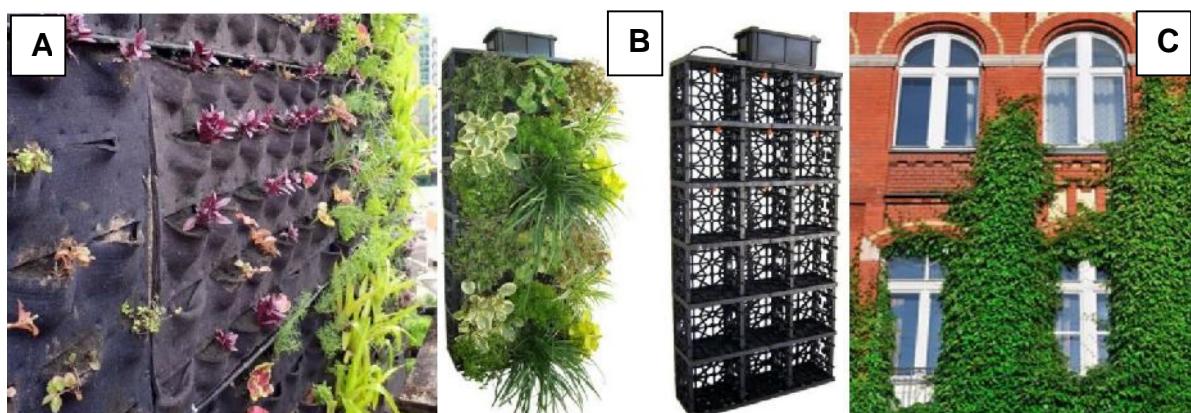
a) Parede verde em feltro; b) parede verde modular-tabuleiro; c) sistema direto.
